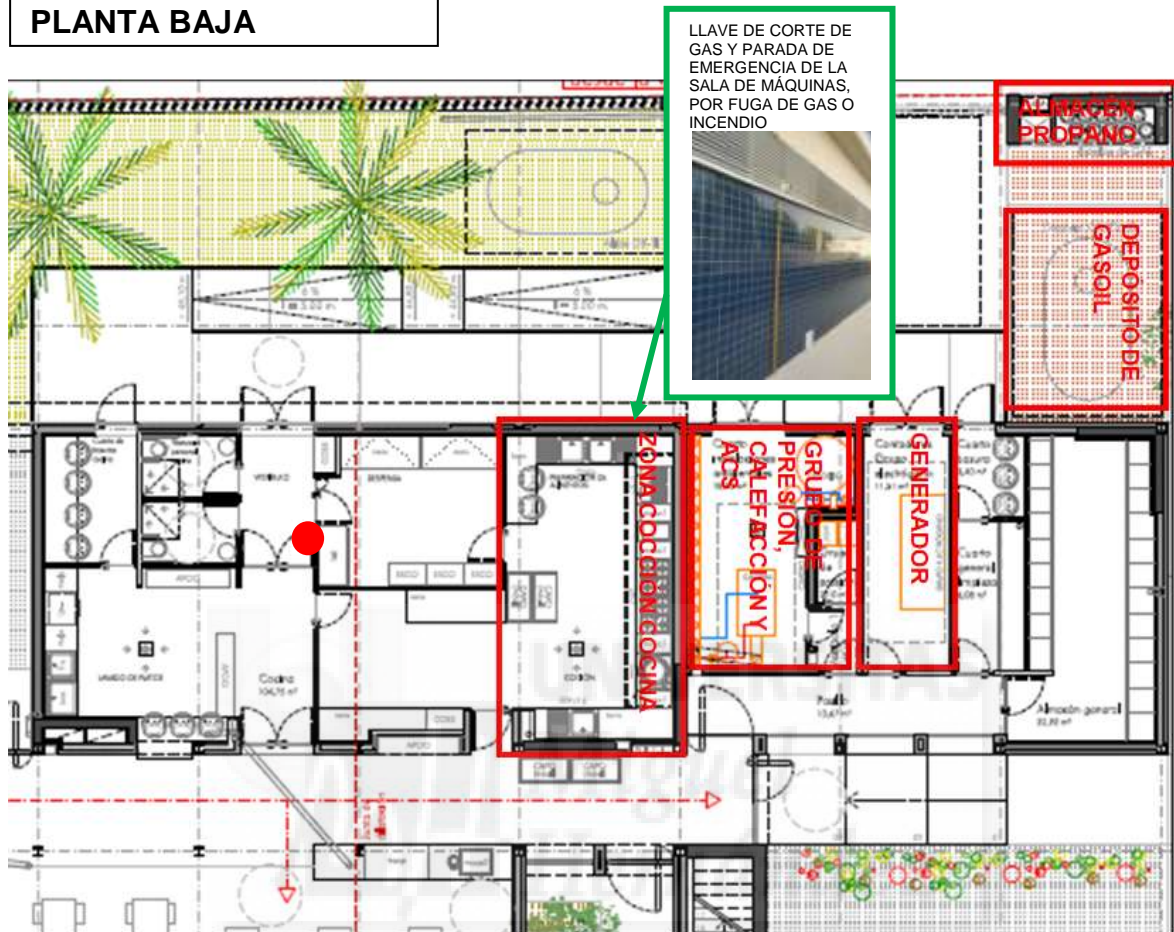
Plano Bloque 3, Planta Baja, localización de instalaciones
